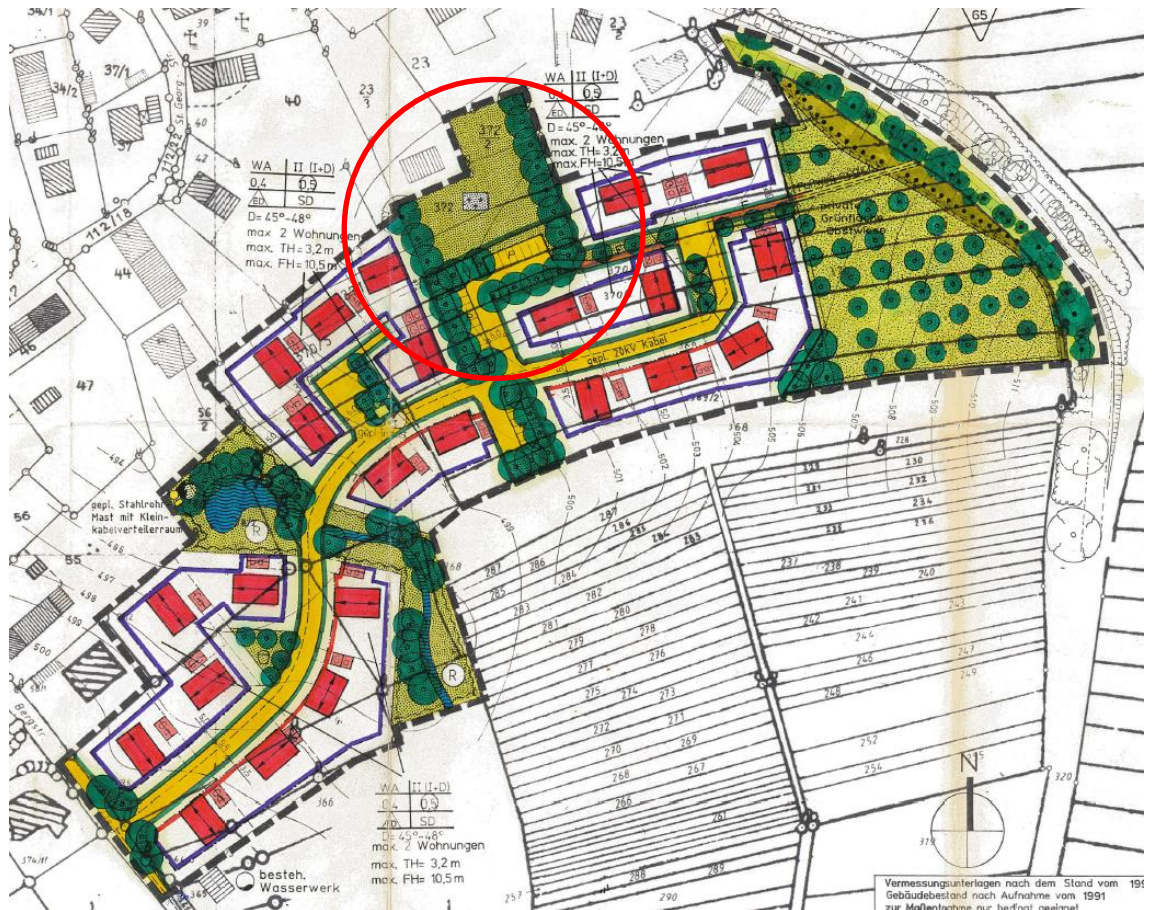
rechtswirksamer Bebauungsplan Nr. 21 „Hinter dem Friedhof“ der Gemeinde Gessertshausen (o. Maßstab)
